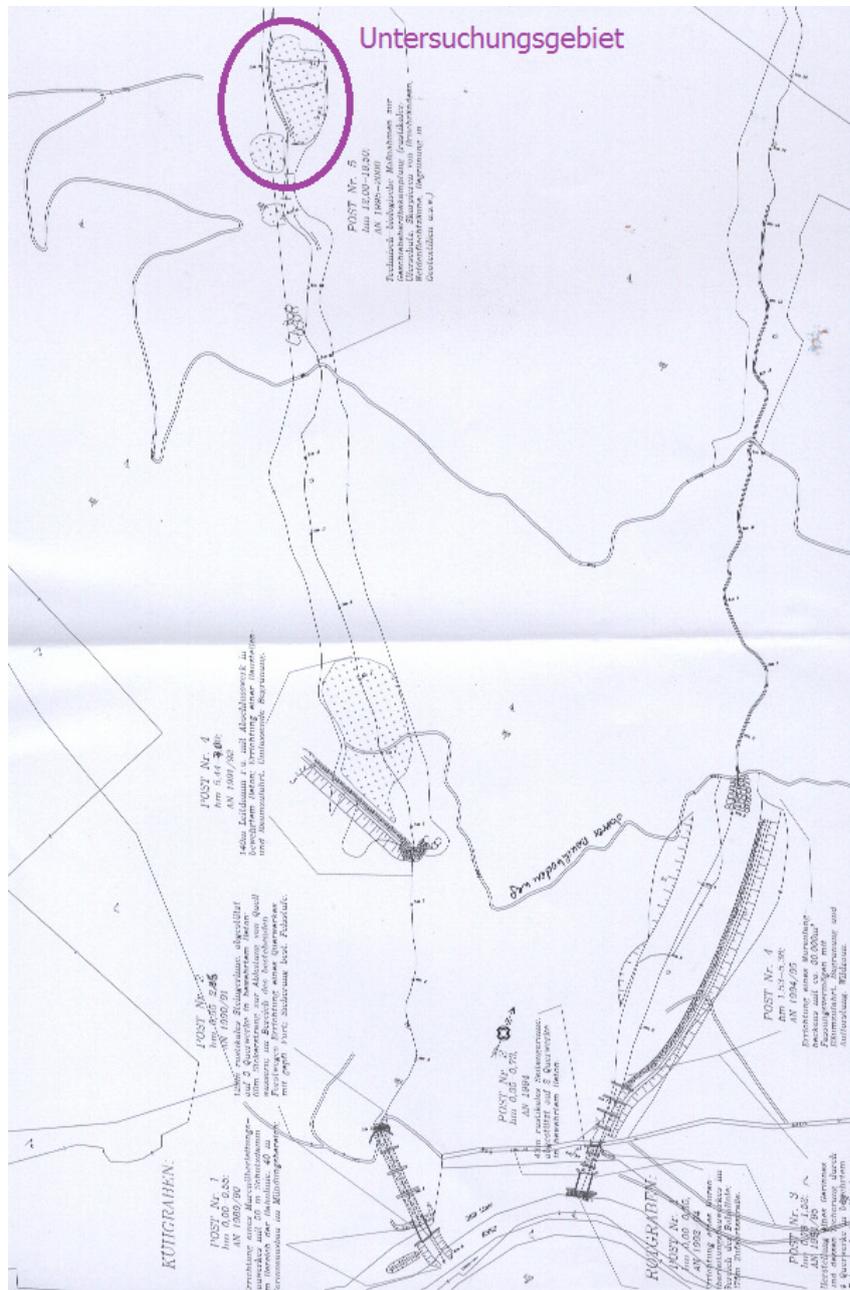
Lageplan des Verbauprojektes Kühgraben (WLV Unteres Ennstal und Salzatal, 1989 – 2000)
